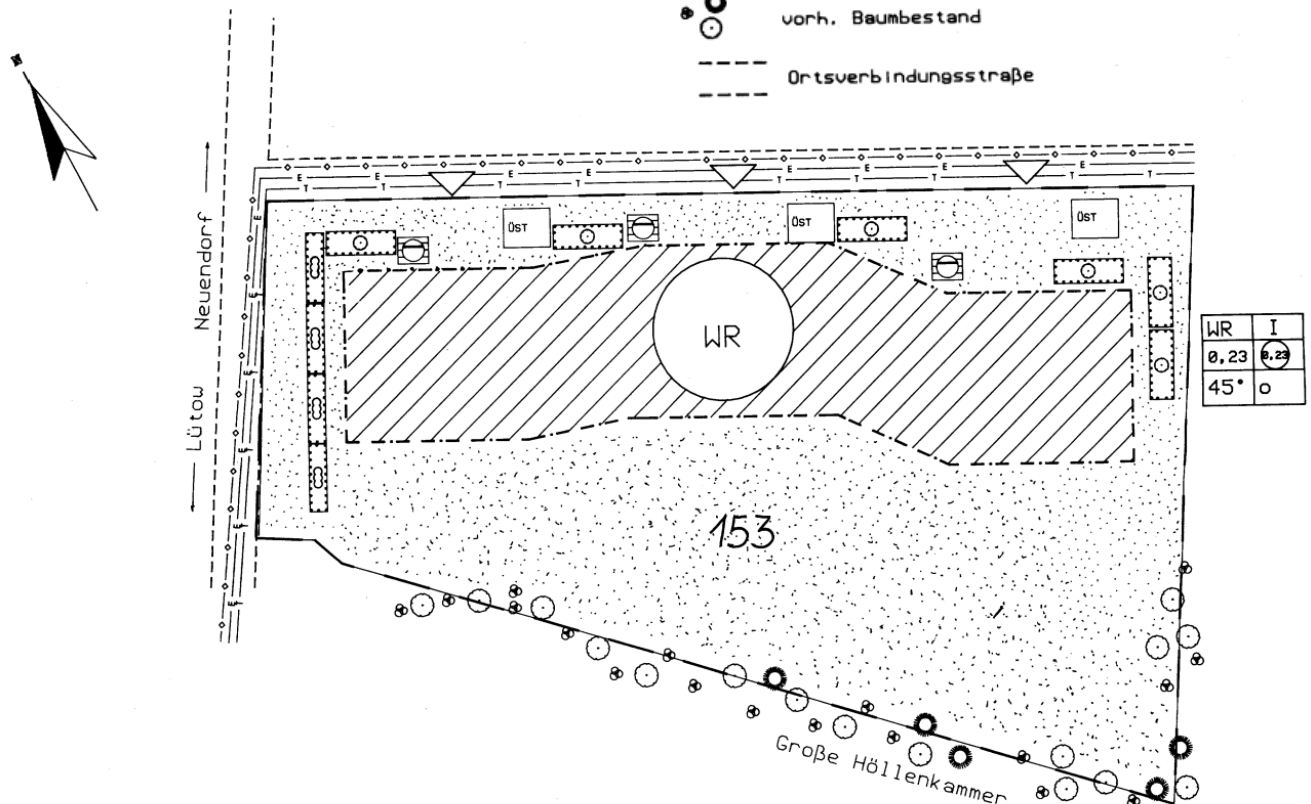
Planzeichnung mit Planzeichenerklärung o.M
